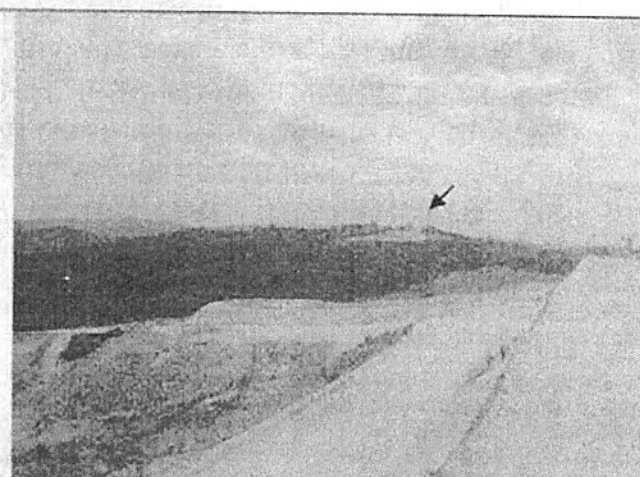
Vista da estrada não pavimentada que dá acesso à área do Aterro Classe I. Vista em segundo plano da biomanta instalada sobre os Aterros existentes.
